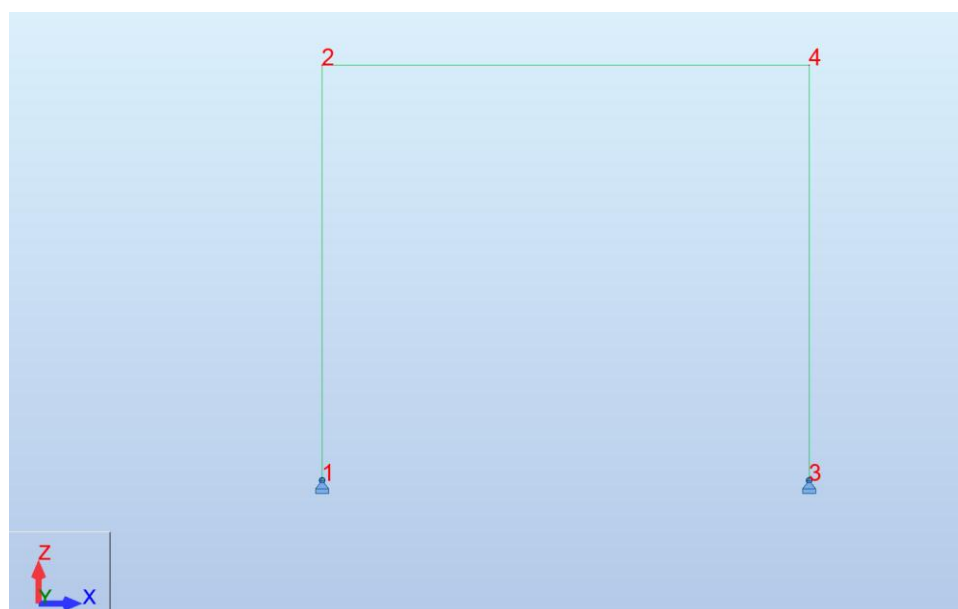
Portique de contreventement en façade – Portique en point haut faitage
